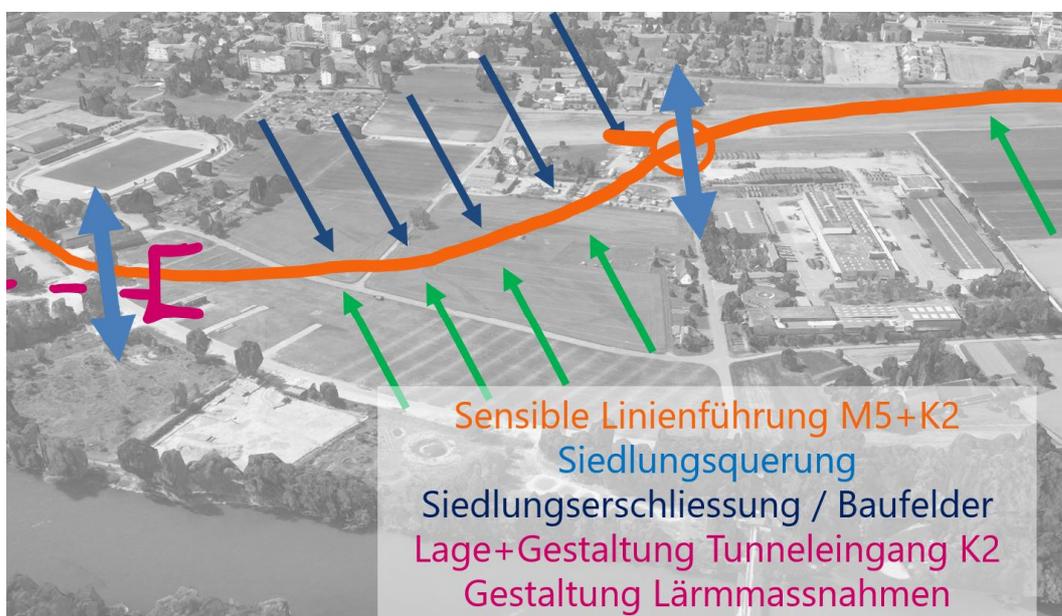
Tunnelportal Nord mit Rampe, Querung Aegerte und Anschluss Auffeld (Quelle: Planteam)
